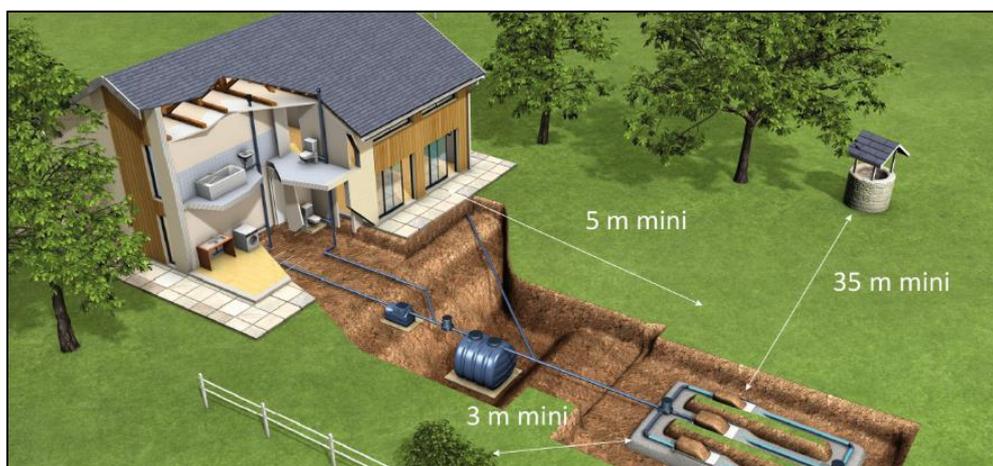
Exemple d'installation d'Assainissement Non Collectif en filière traditionnelle
